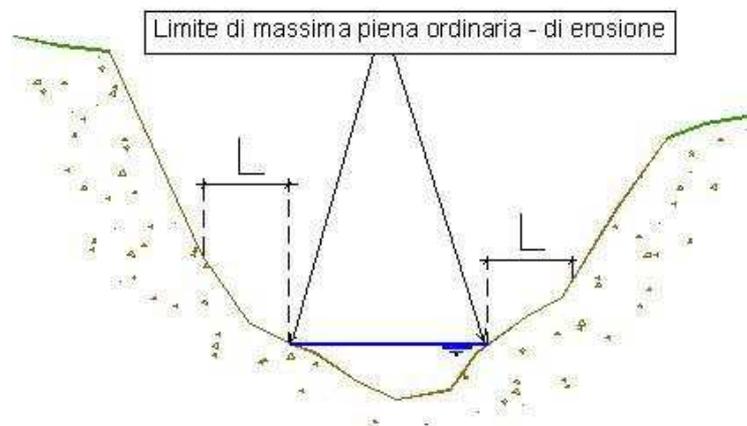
Schemi grafici per la definizione delle fasce di rispetto
